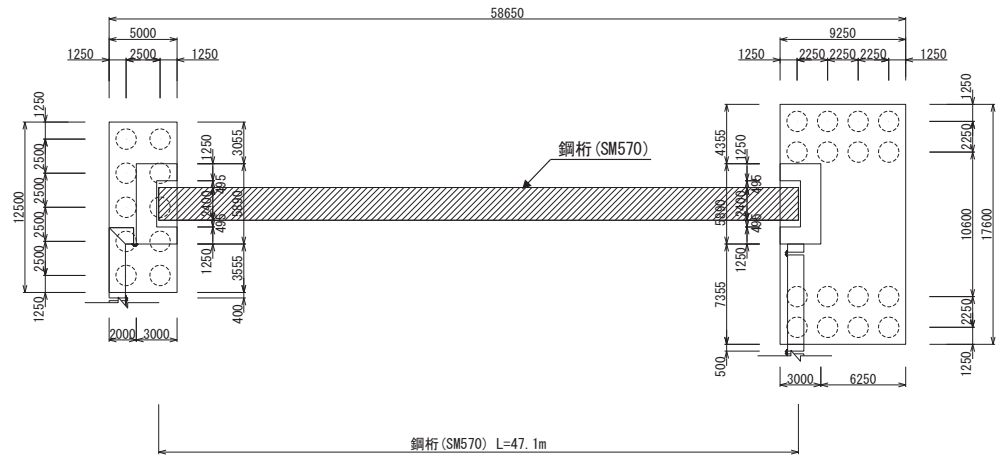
(2) 鋼製遮水壁（鋼桁 4） 平面図
